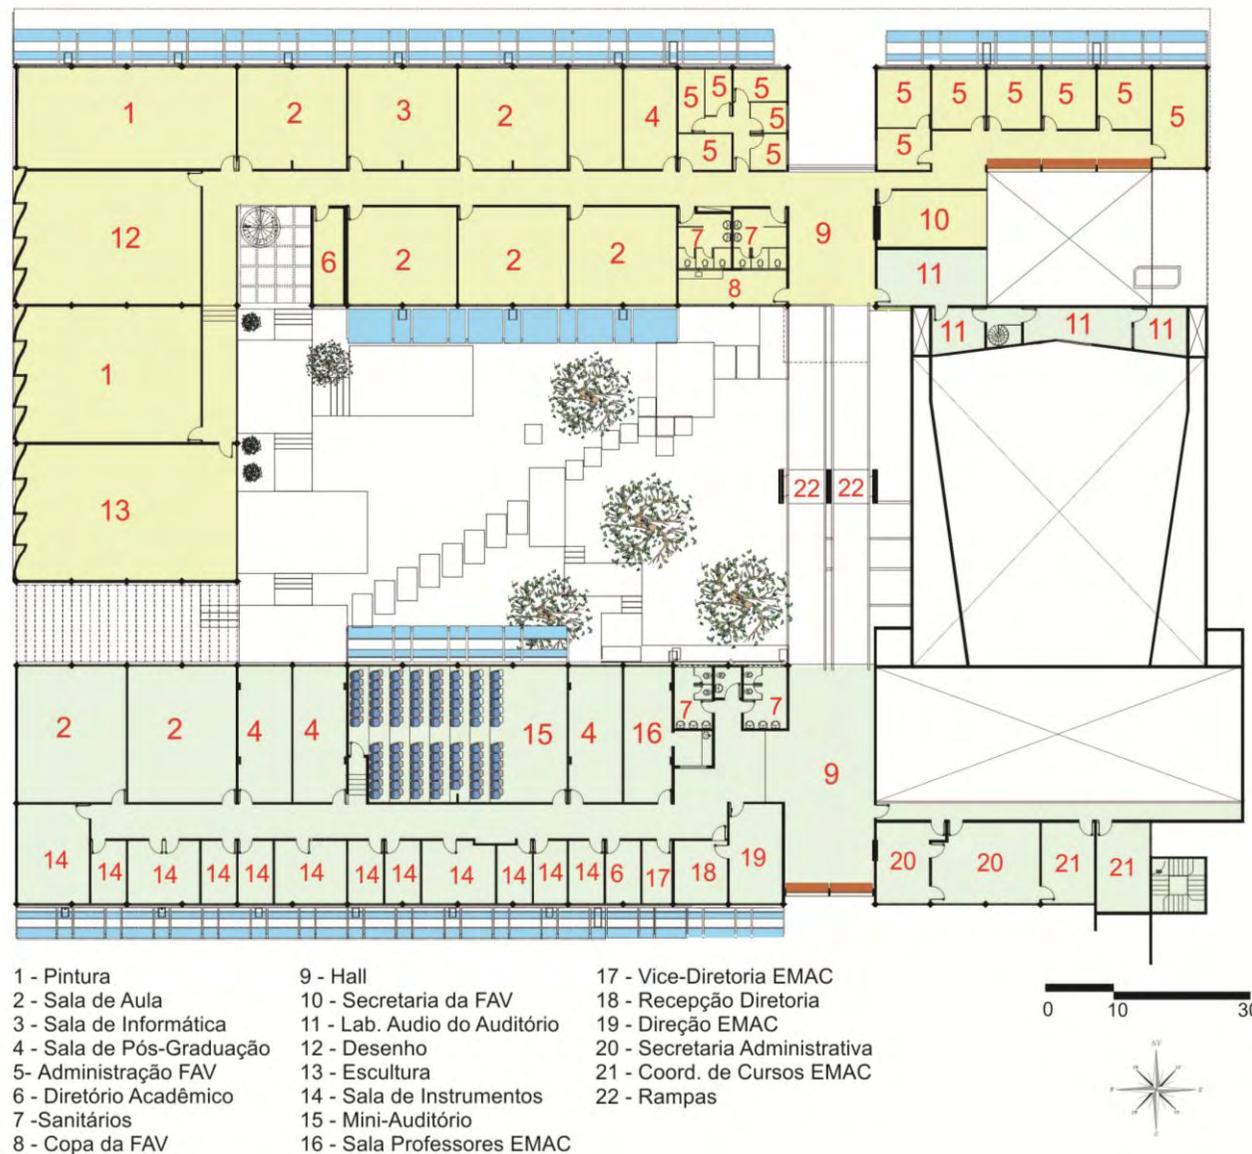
Pavimento superior do edifício em estudo. Adaptado arquivo Cegef (2011)
